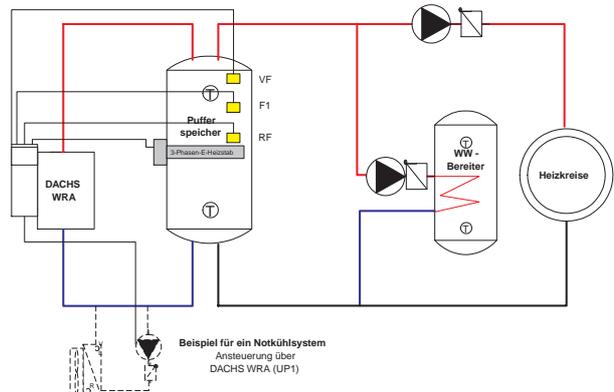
Beispiel einer hydraulischen Einbindung für Wärme- und Stromführung
